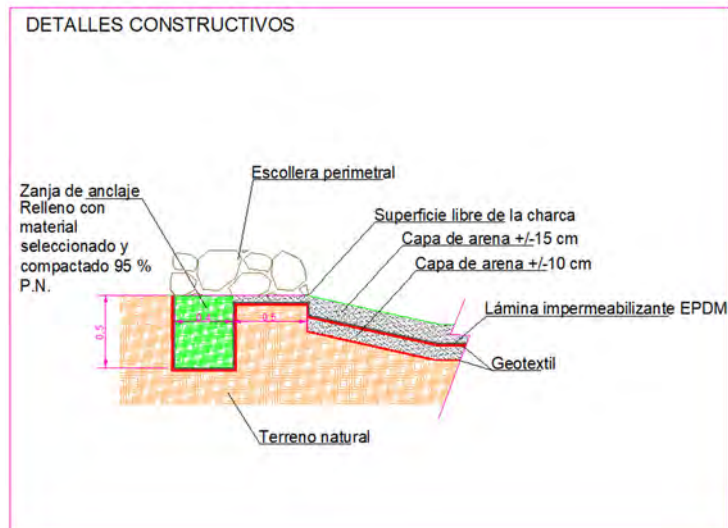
Detalle constructivo de las capas que conforman la impermeabilización y su anclaje
